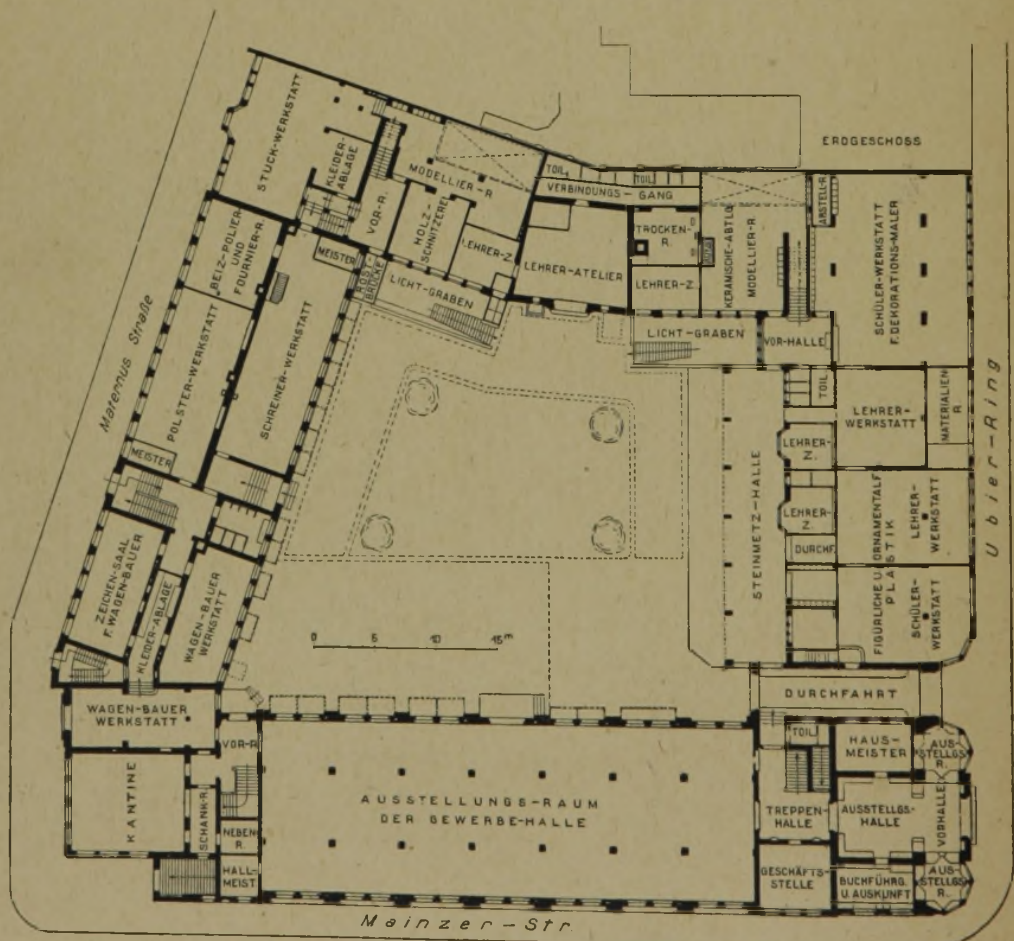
Grundriß des Erdgeschosses. (1 : 600.)
